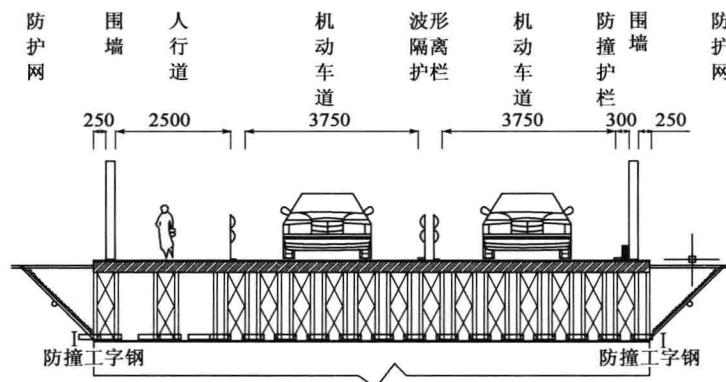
12m 宽钢便桥横断面示意图(尺寸单位:mm)
